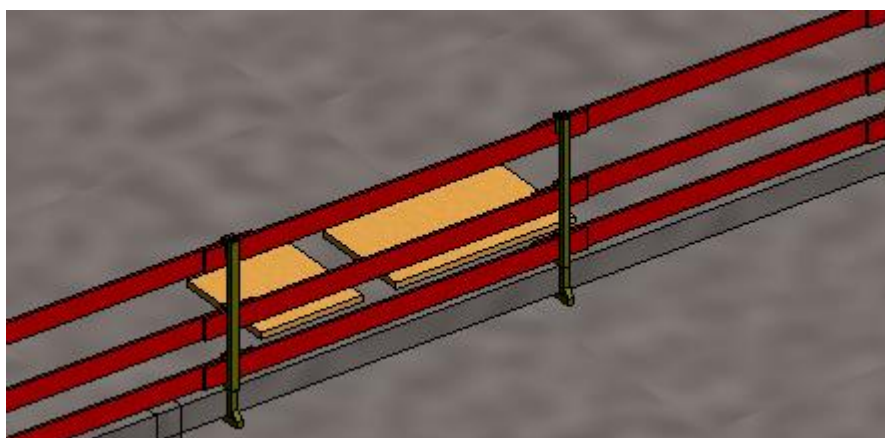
Exemplo de aplicação de guarda-corpos na extremidade da laje
